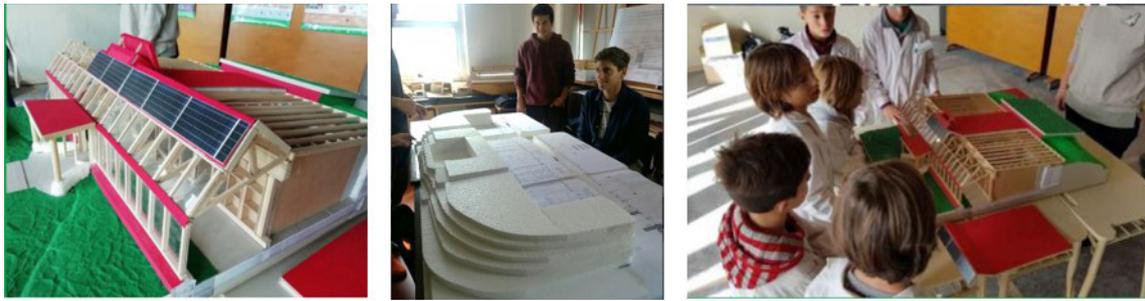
Elaboración de maqueta desmontable con detalles constructivos.
